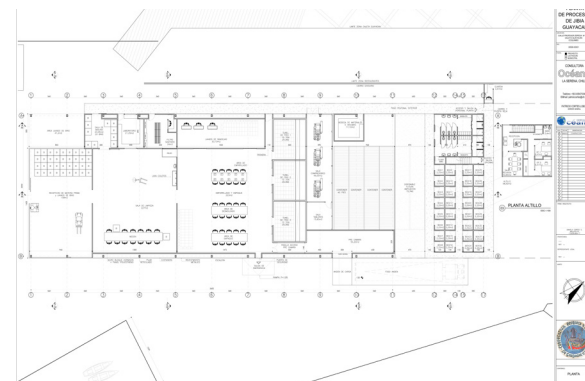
Planta de Proyecto de Planta Procesadora de la Jibia
